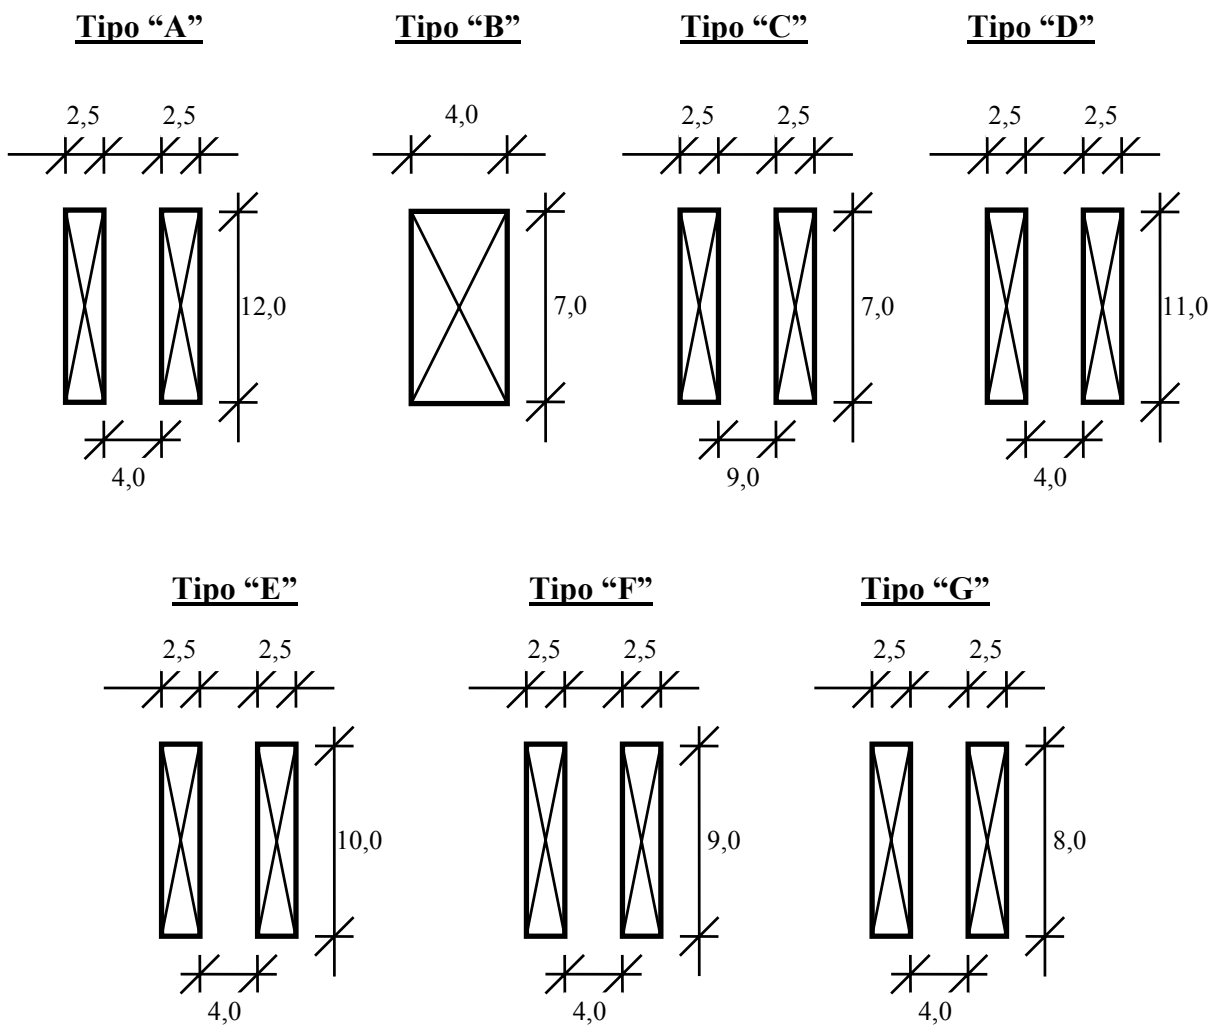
Tipos de seções transversais dos elementos estruturais
